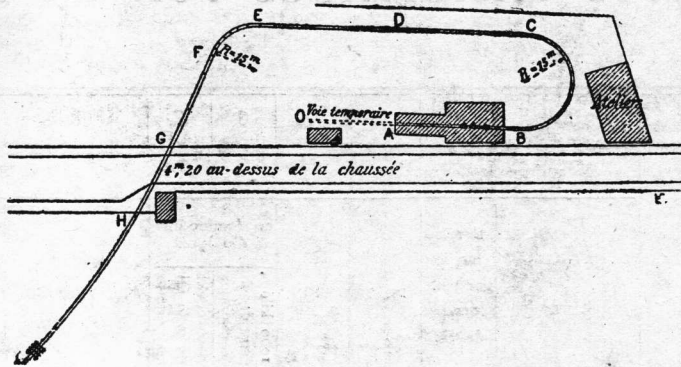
Plano de la vía de ensayo construida en Cambridge, cerca de Boston.
